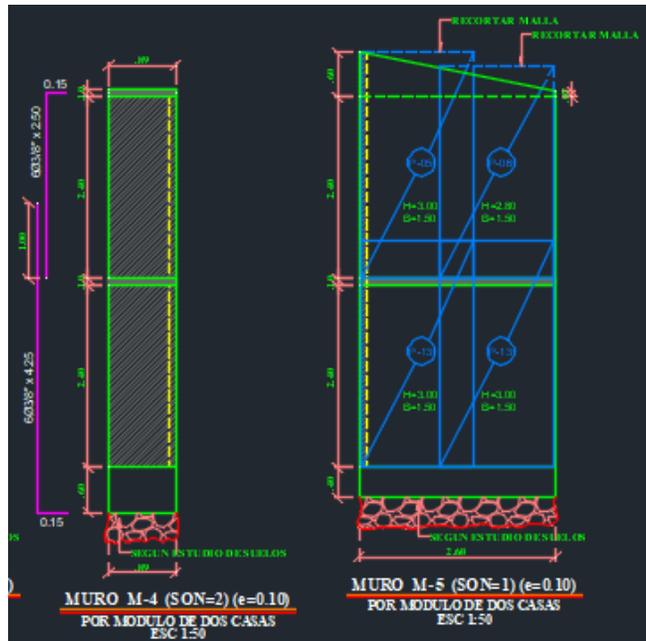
Modulaci3n y Dimensiones Muros M4 y M5 del proyecto Villas del Duruelo.
